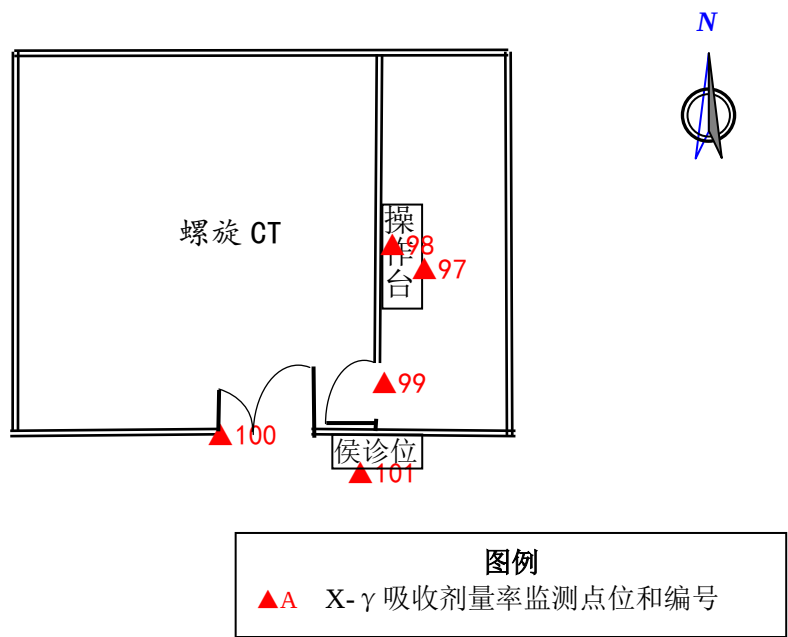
螺旋 CT 机房平面布置简图及监测点位图
